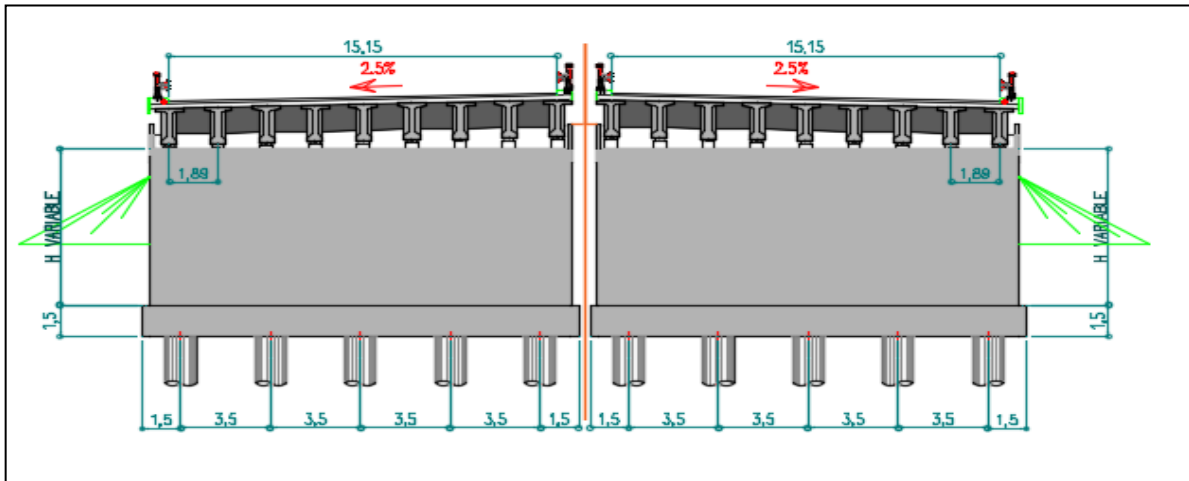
Coupe transversale sur culée VARIANTE 01
